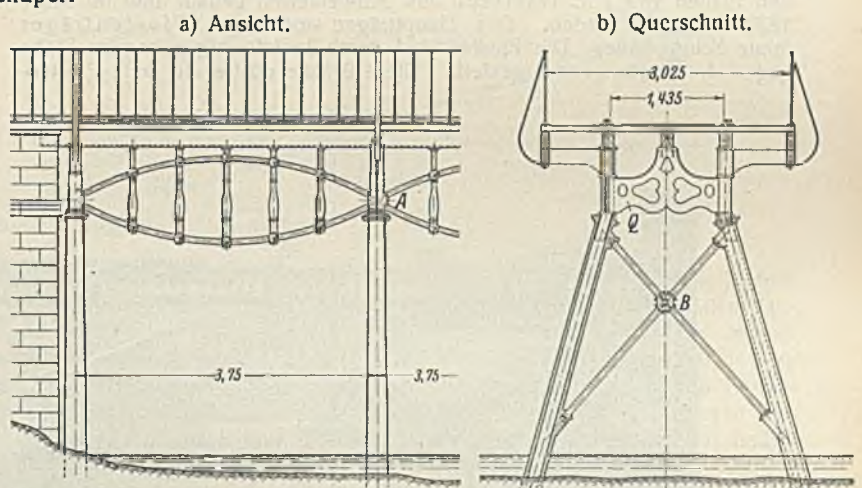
Erste eiserne Eisenbahnbrücke der Welt.
